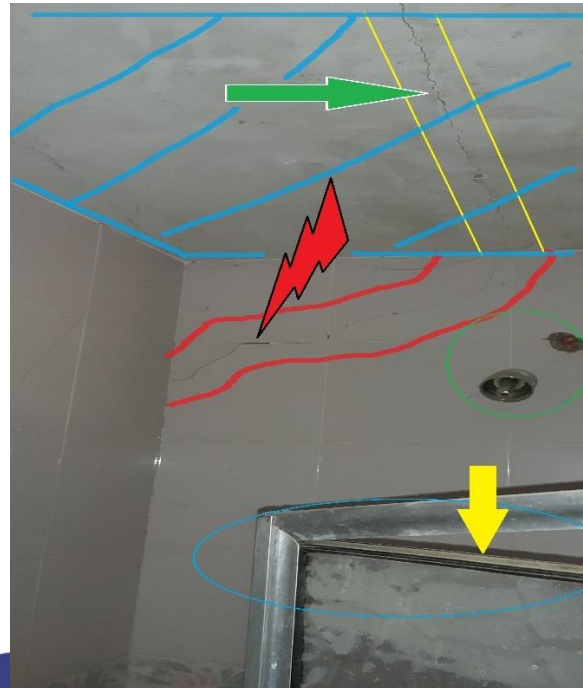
y 72: Grietas presentes en muros y losas, Afectación de elementos estructurales y no estructurales, se evidencia la rotura del muro y la losa, presencia de humedades y agentes biológicos.
